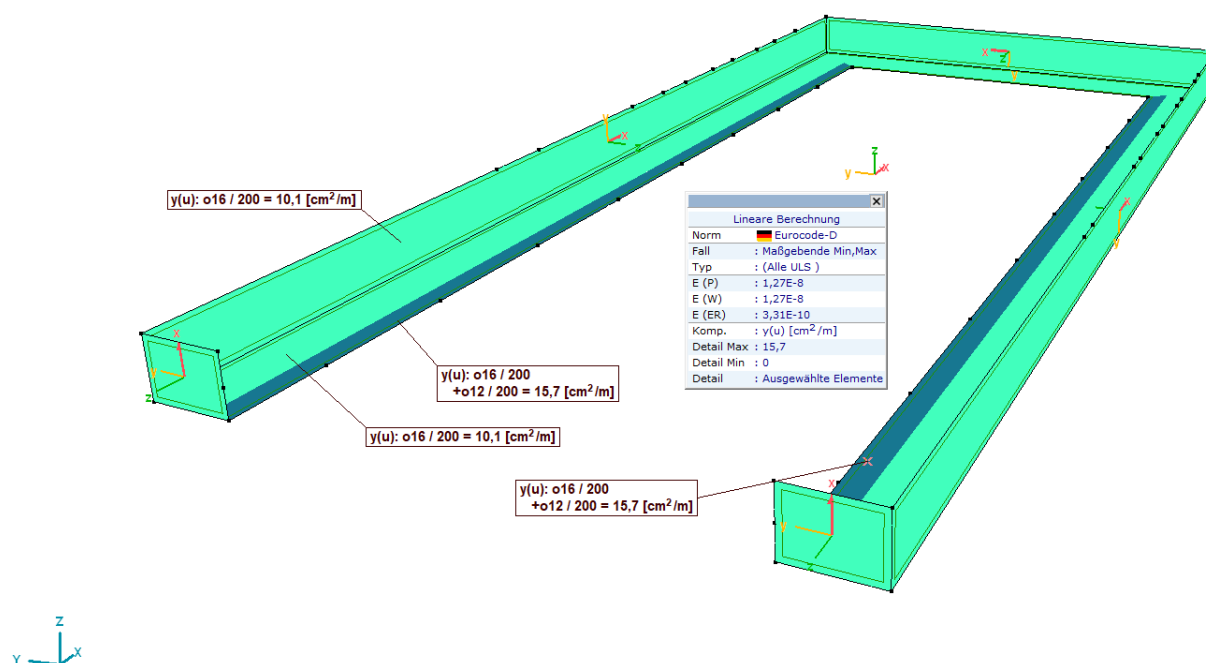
Entworfenere Bewehrung außen/unten in lokaler y-Richtung
